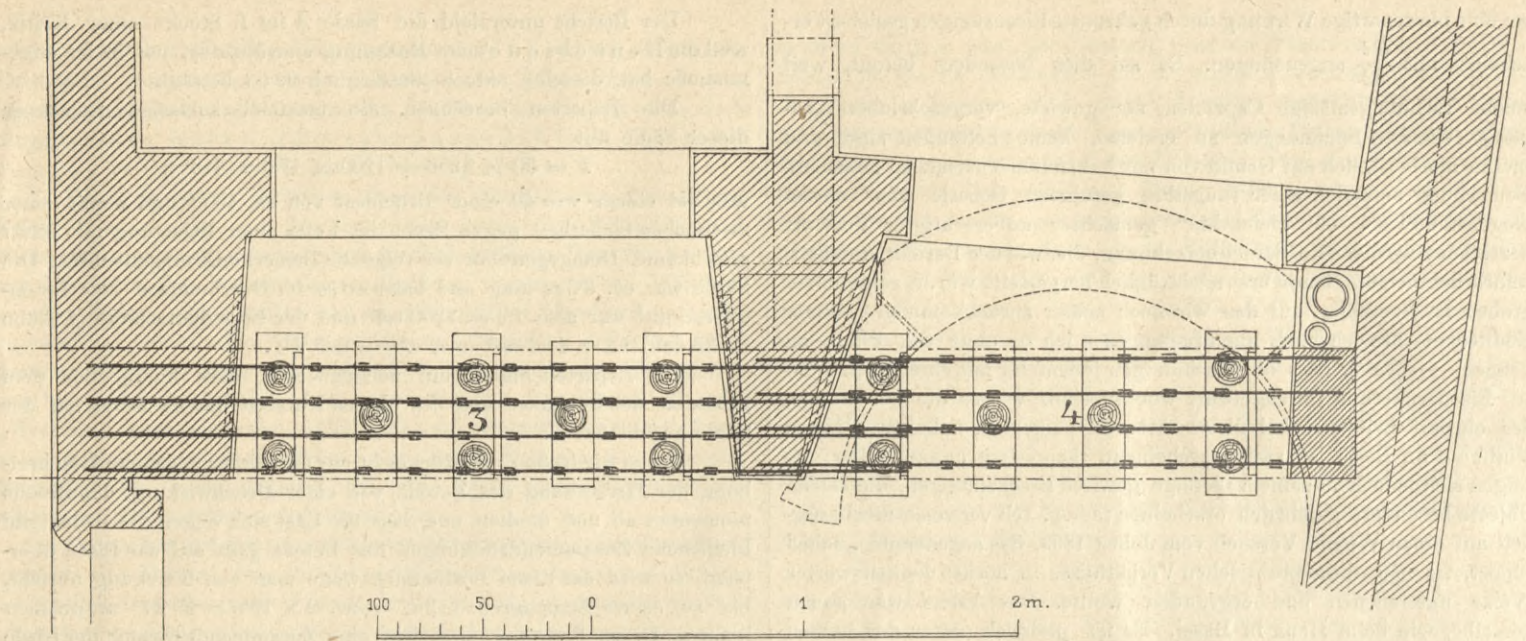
Detail der zwei unterfangenen Träger aus dem 1. Stock.
